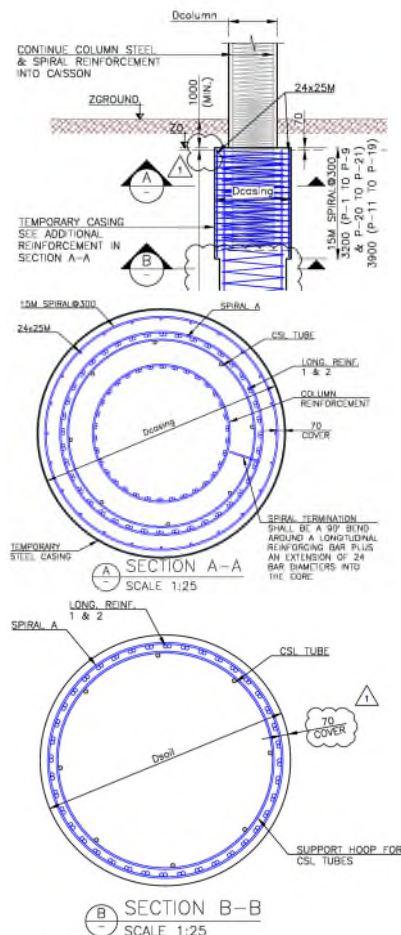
Detalle de solape de armadura entre Pila y Pilote.
